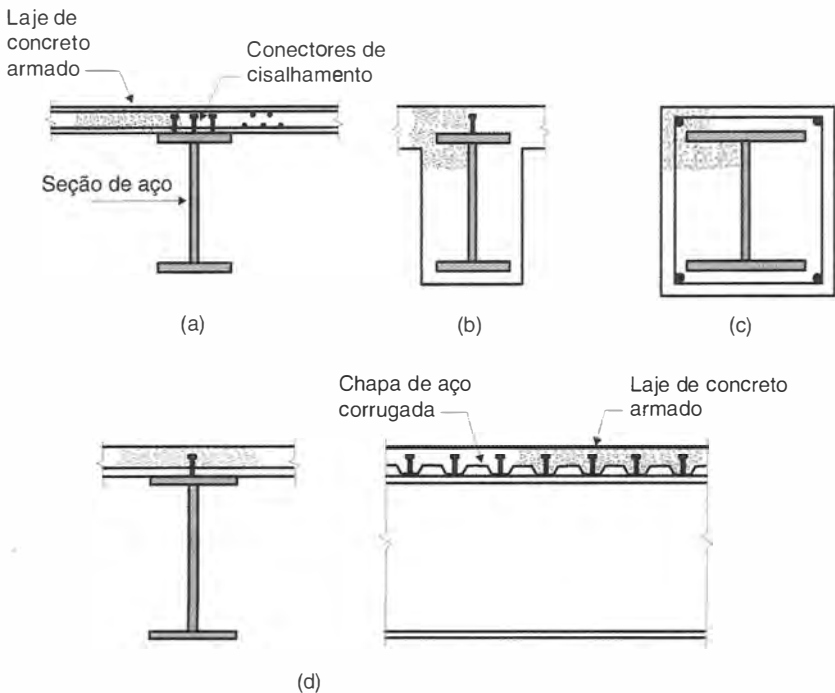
Estruturas mistas aço-concreto: (a) viga mista típica e seus elementos; (b) viga com perfil de aço embebido no concreto; (c) pilar misto; (d) viga mista com fôrma metálica (*steel deck*) com nervuras dispostas perpendicularmente ao eixo da viga.
